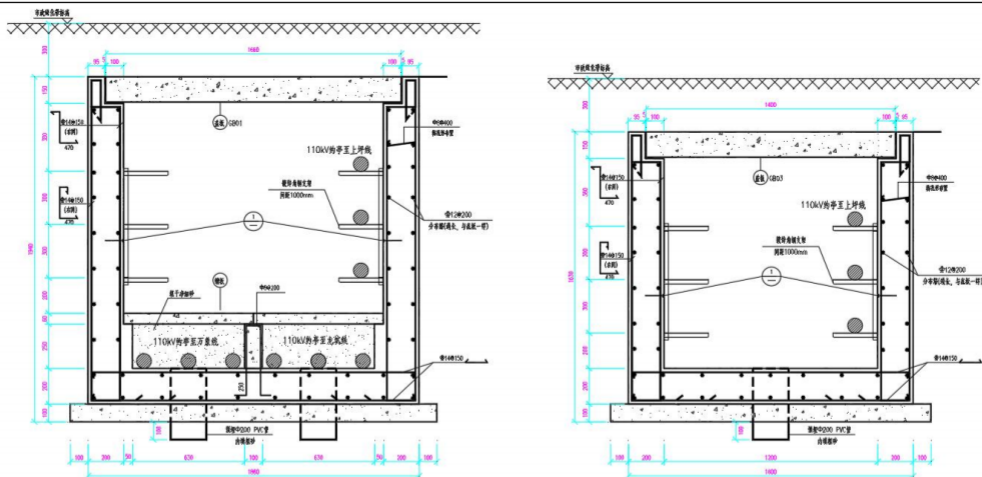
电缆沟断面图（单位：mm，左为四回路，右为双回路）
